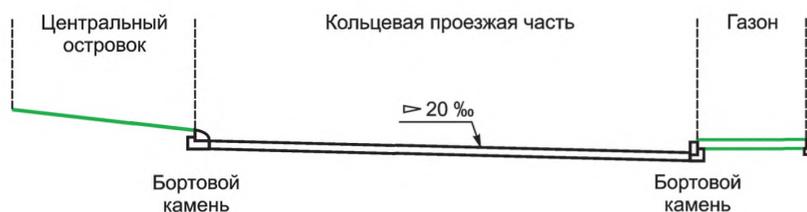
Типовой поперечный профиль кольцевого пересечения без пониженной части центрального островка
